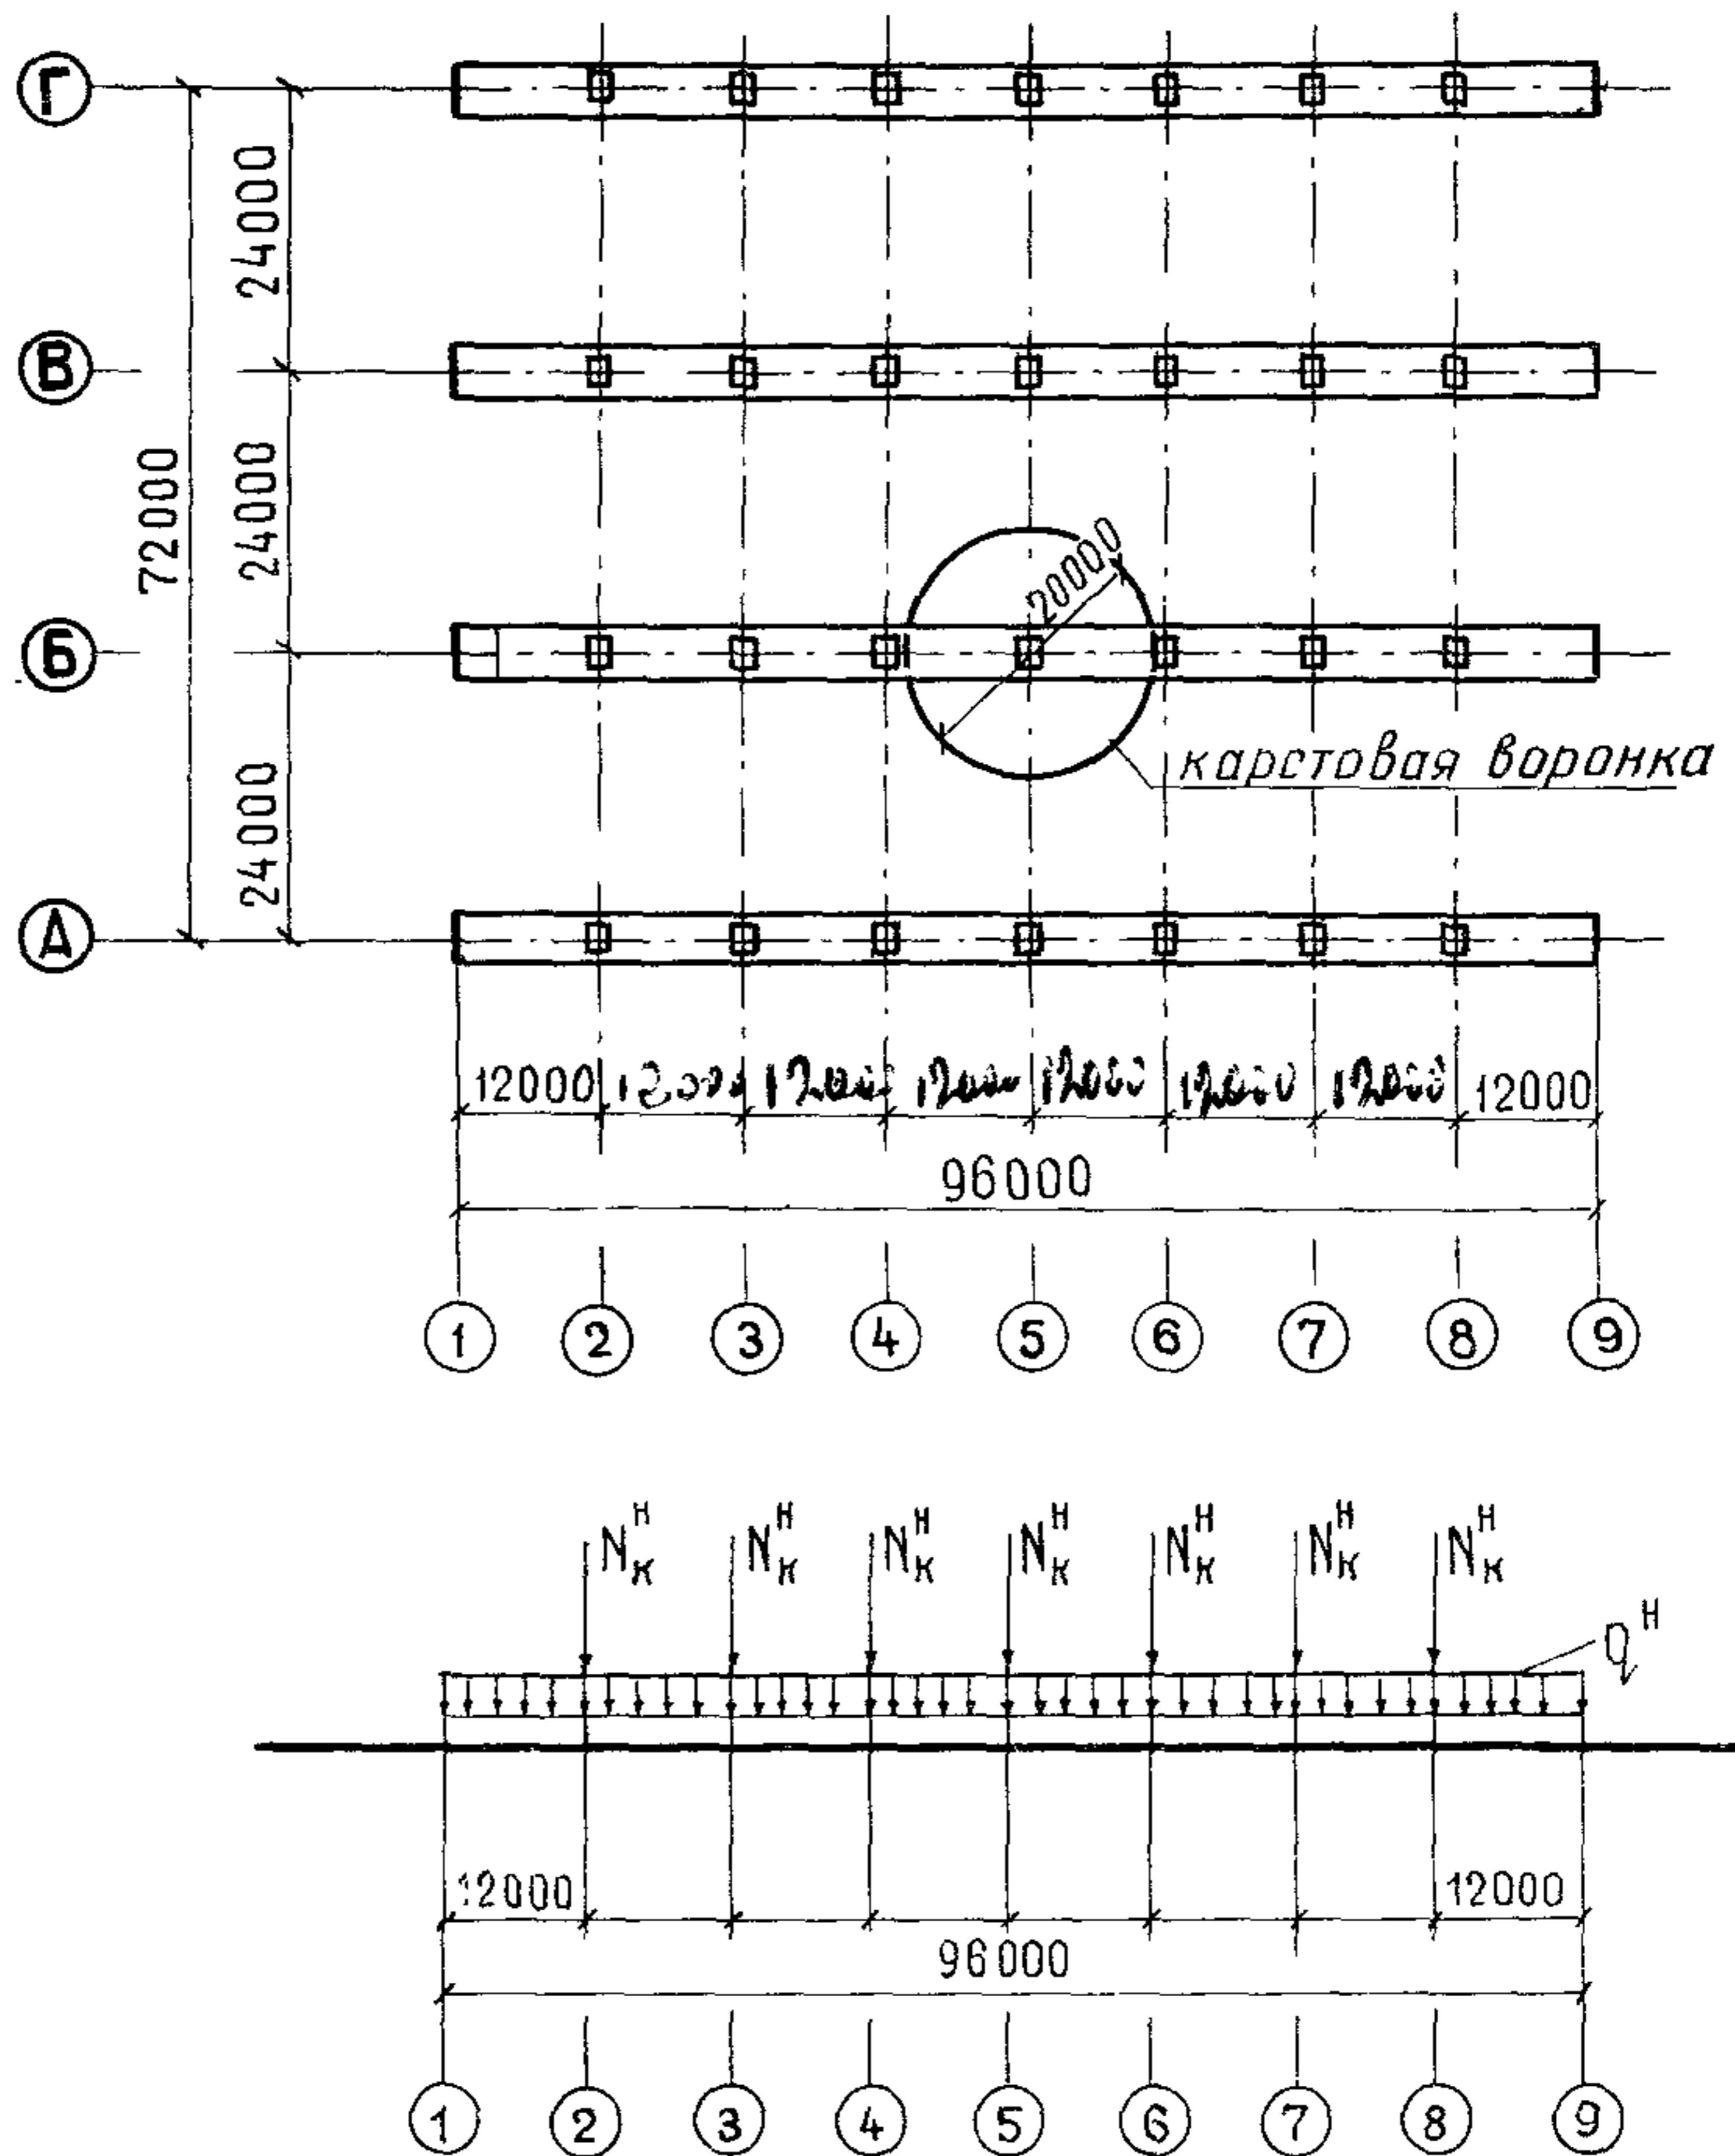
План фундаментов и расчетная схема балки на сплошном узугом основании
